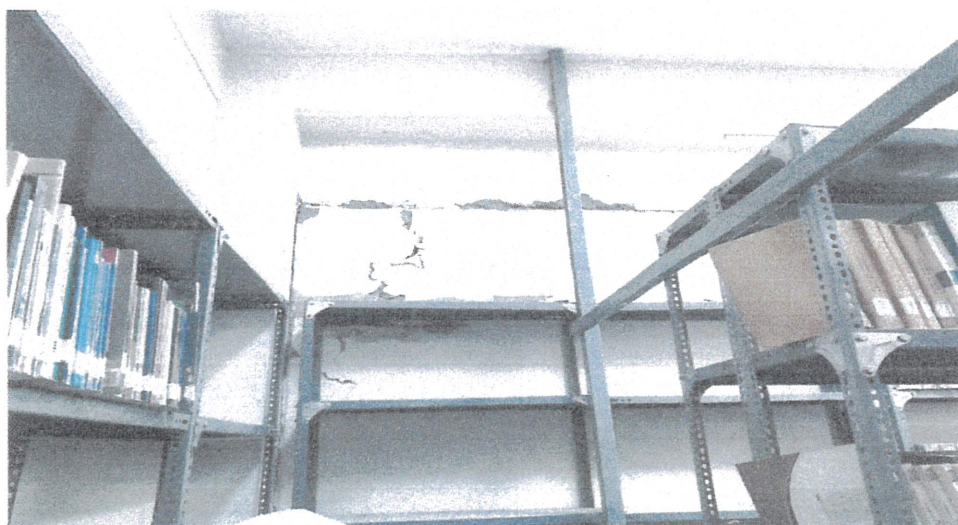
Presencia de fallas en junta fría entre el muro de albañilería y viga principal en la biblioteca central.
